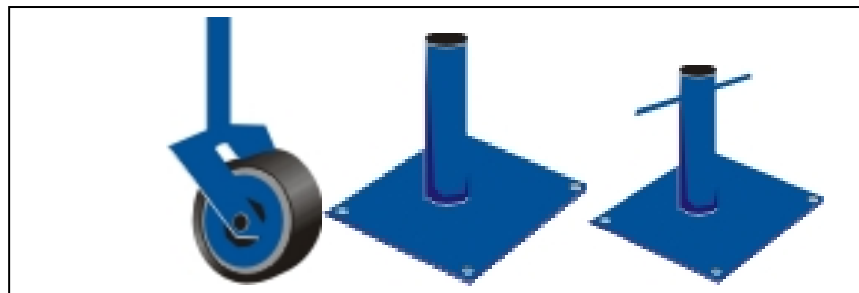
Elementos para mobilização e fixação de andaimes simplesmente apoiados.
